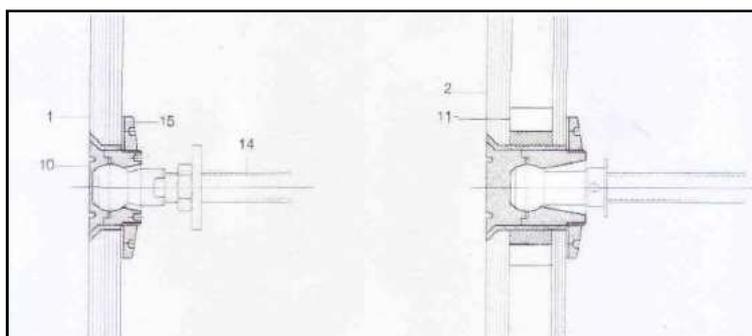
Esempio di fissaggio sul piano di superficie, con articolazione esterna al piano di lastra
